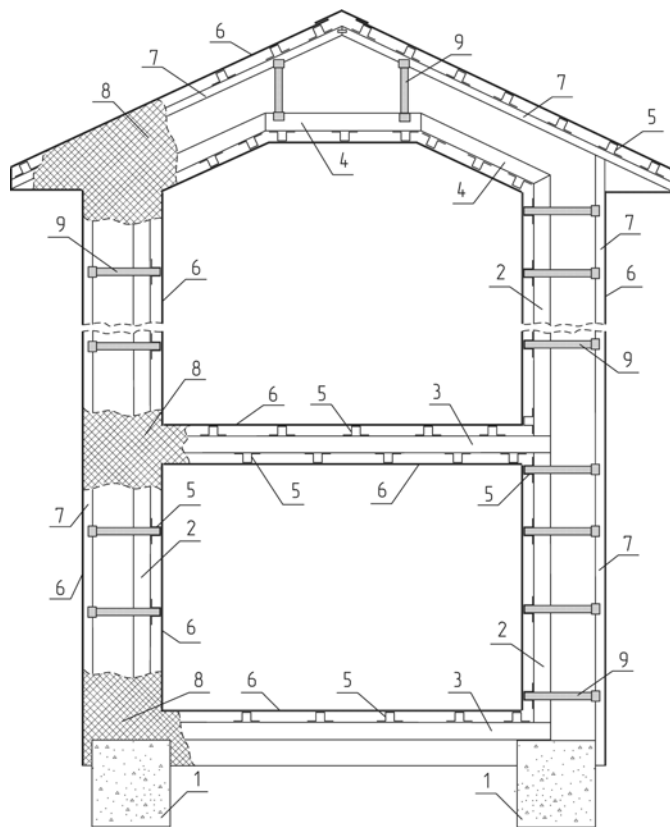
Поперечный разрез здания: 1 – фундамент; 2 – колонна внутреннего каркаса; 3 – ригель внутреннего каркаса; 4 – балка перекрытия; 5 – гнутый профиль; 6 – лист опалубки; 7 – внешний каркас; 8 – лёгкий бетон; 9 – временный фиксатор.
